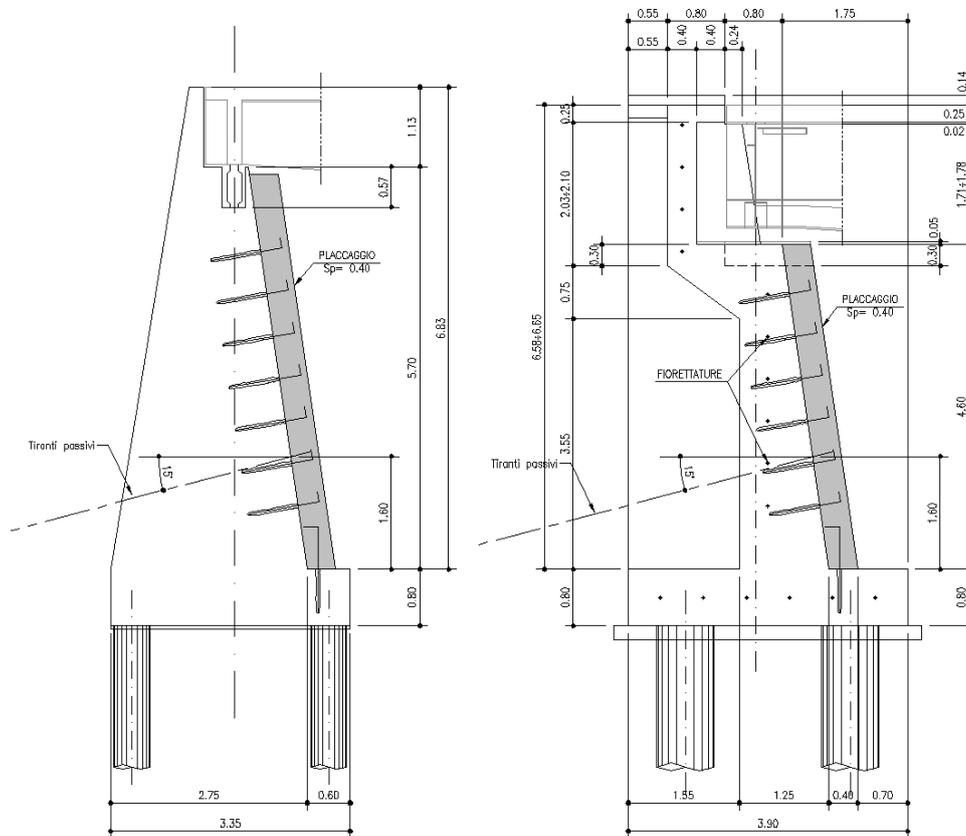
Ponte sul Lambro: sezione dei muri di spalla
